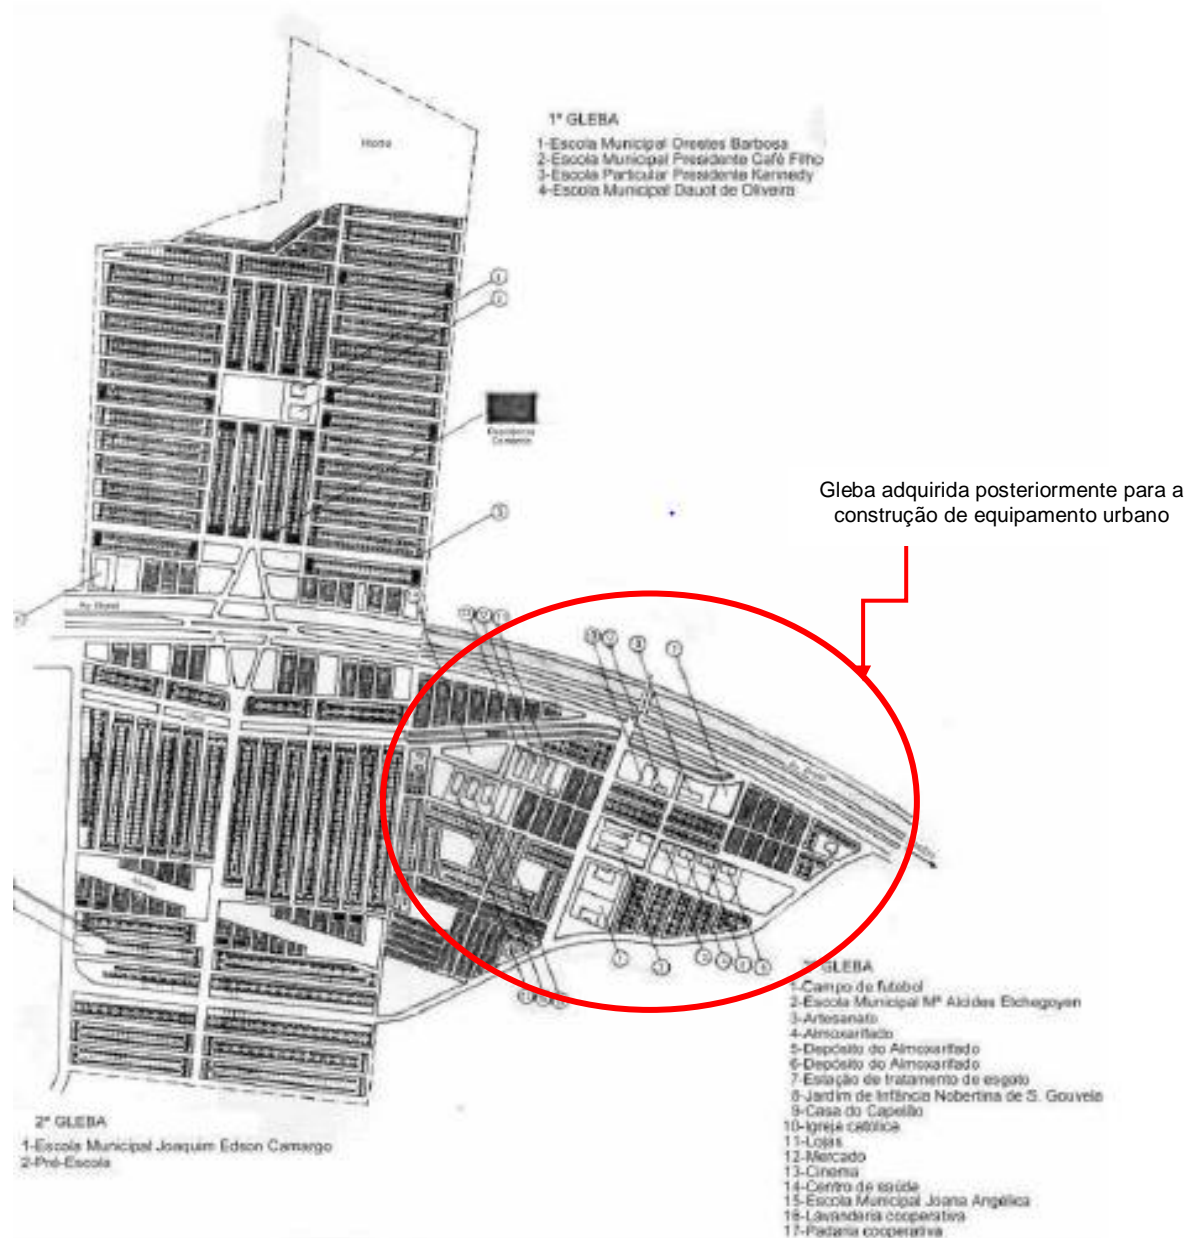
Planta baixa do conjunto de Vila Kennedy.
